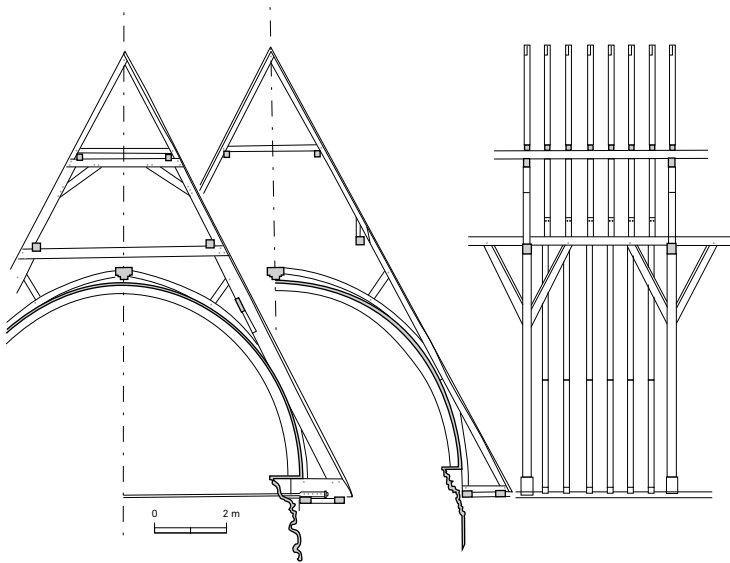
Langsdoorsnede door de koorkap: zicht op een typisch hoofdspant (tekening D. Nuytten).
